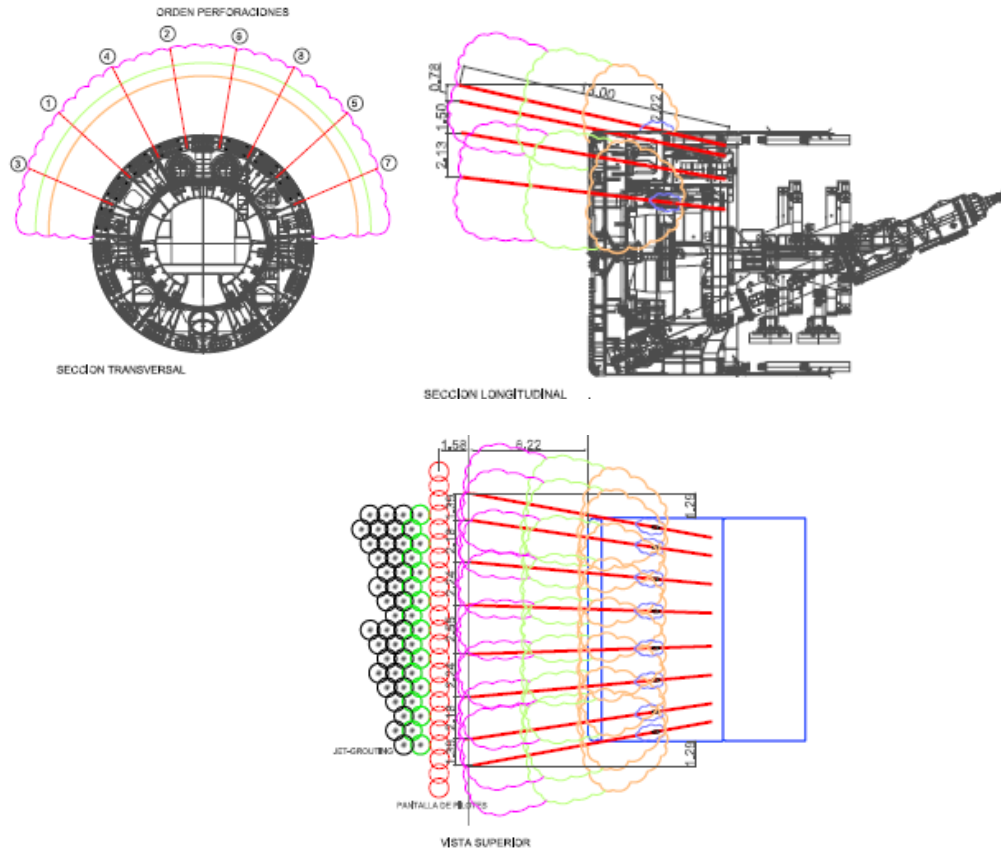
Vista en planta, alzado y perfil de las inyecciones de resina.
